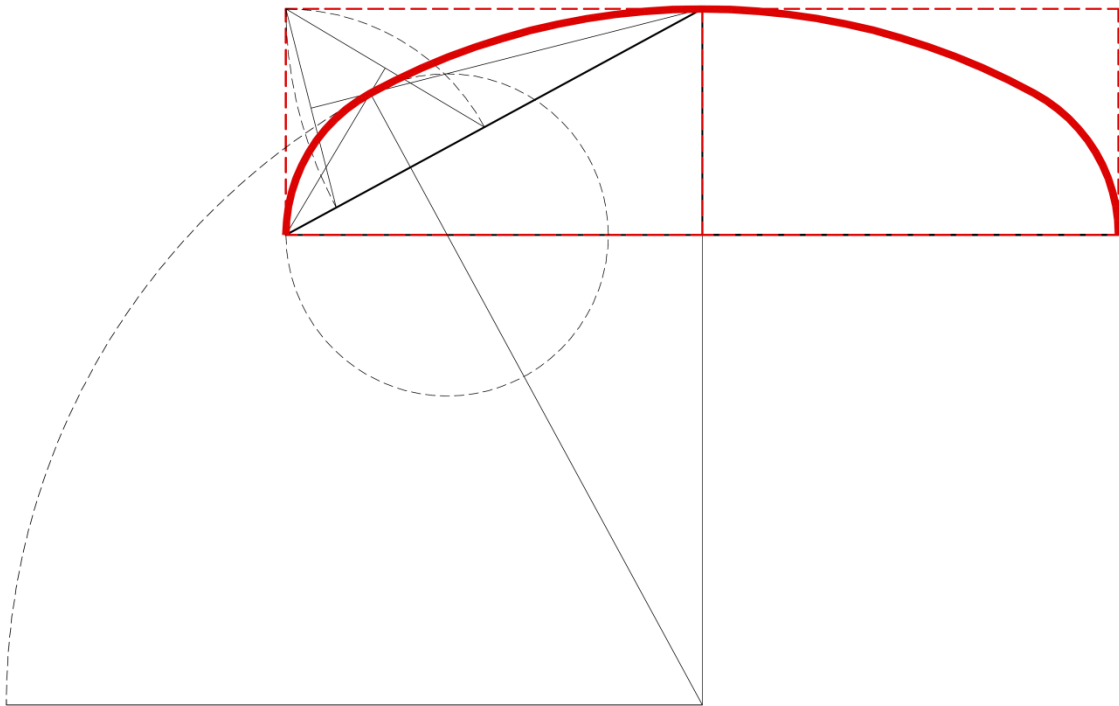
Detalle trazado arco carpanel bajo coro - pila bautismal
